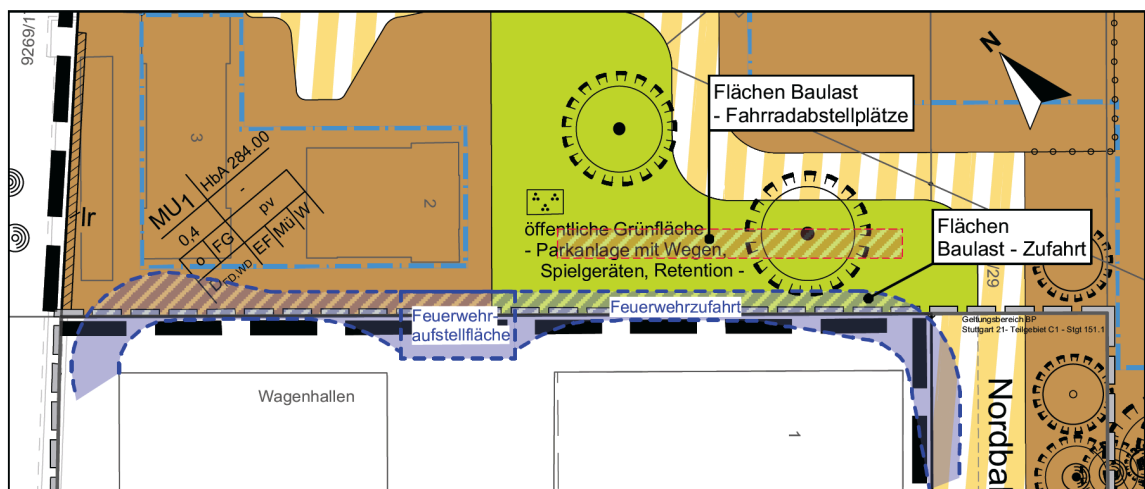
bestehende Baulasten: schaffierte Flächen blau - Zufahrten, Feuerwehruzufahrt und -aufstellflächen/ schaffierte Flächen rot – offene Fahrradabstellplätze
